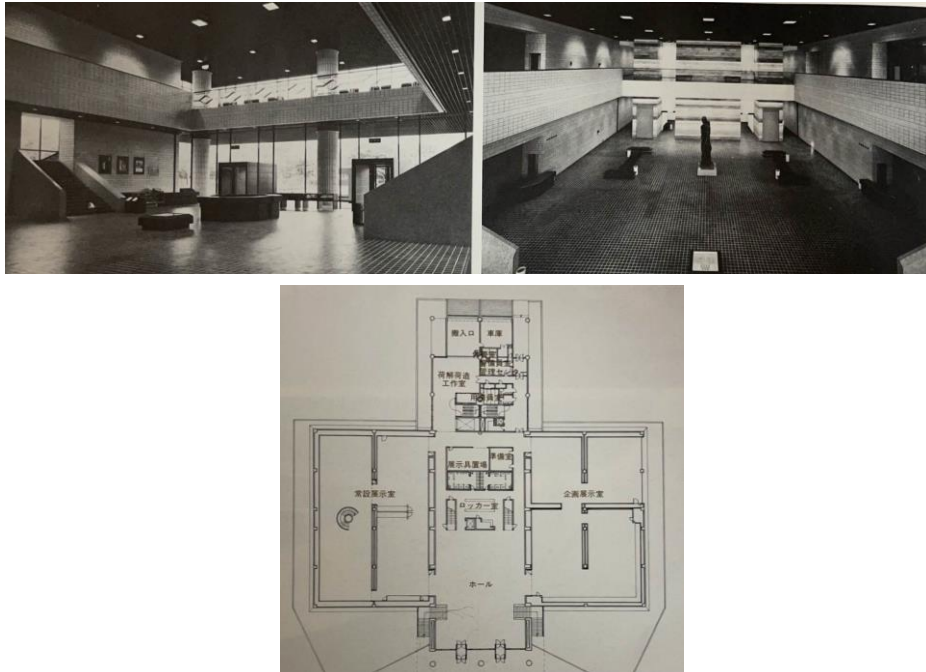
北海道現代美術館 ホールの写真、1階平面図
